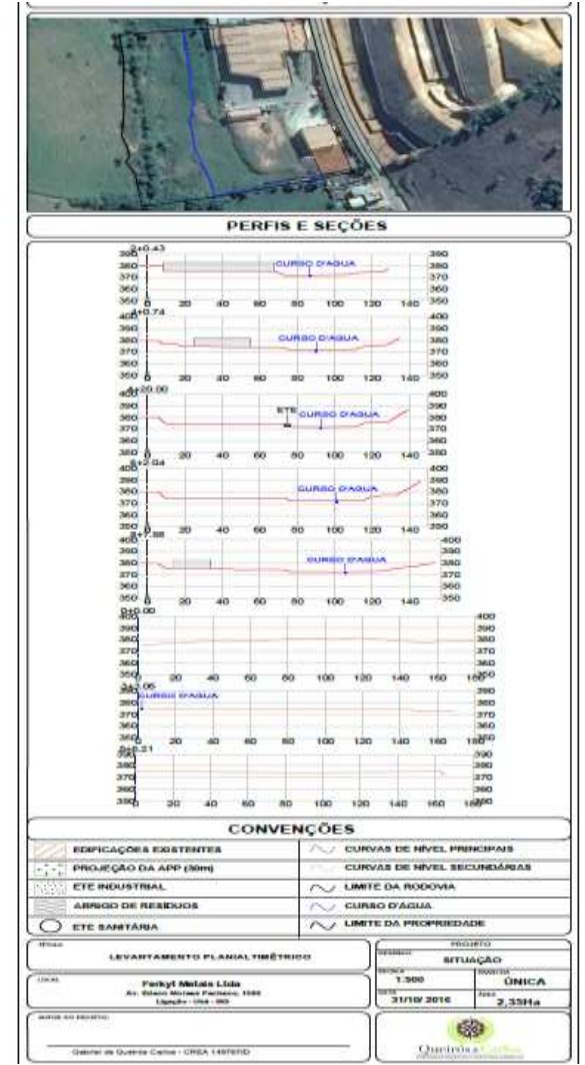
planta do empreendimento delimitando a APP e as suas intervenções
